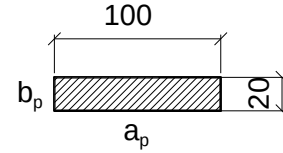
Perímetro do pilar – superfície crítica C.
